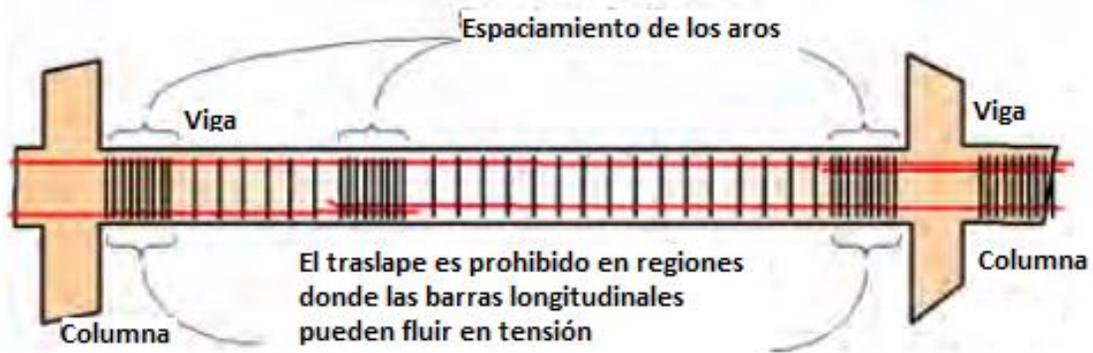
Los estribos deben tener poca separación en los extremos de las vigas y en el los tralapes (fuente: Murty 2005).
